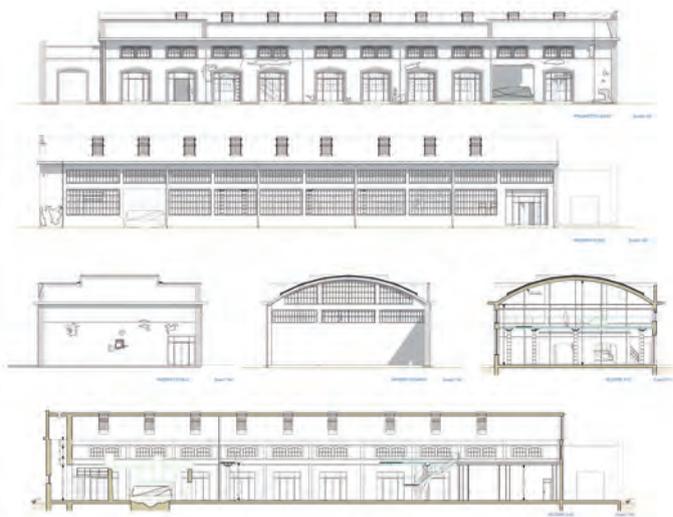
Progetto di riuso dell'ex segheria Figaia: prospetti esterni e sezioni longitudinale e trasversale
